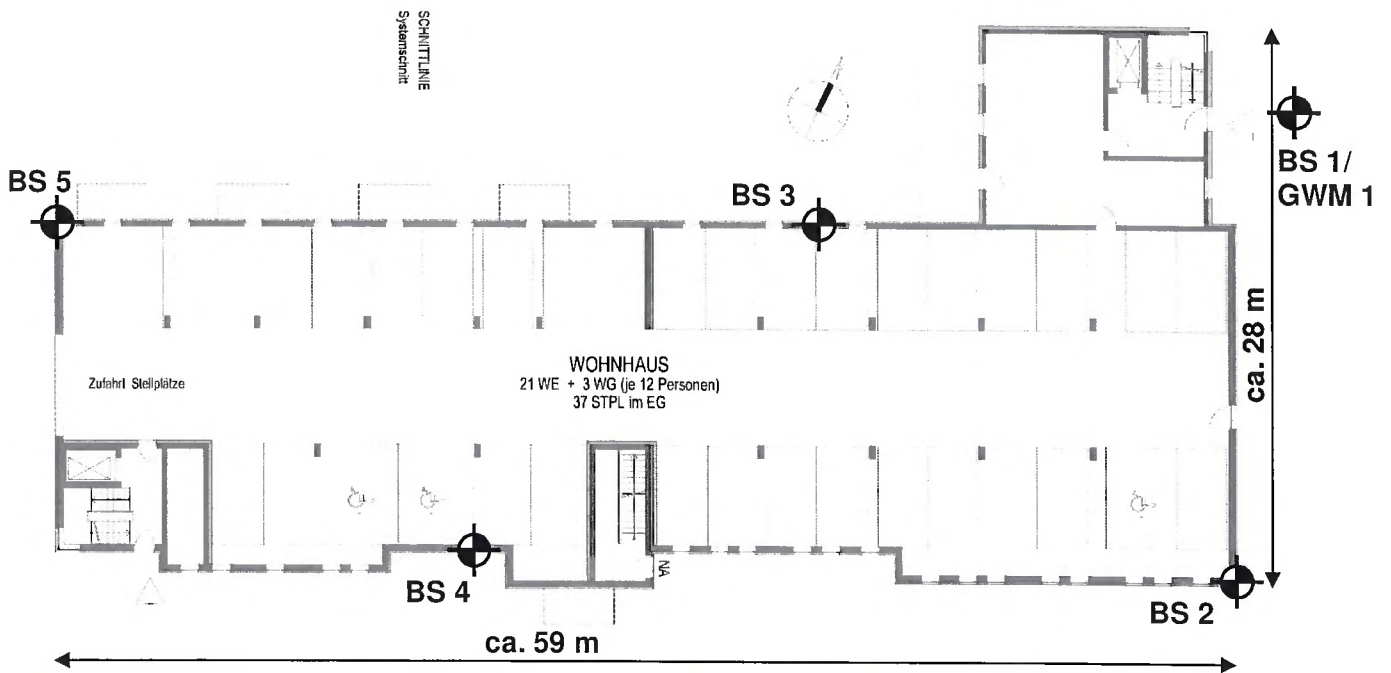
Erdgeschossgrundriss Haus 3, M 1:375
